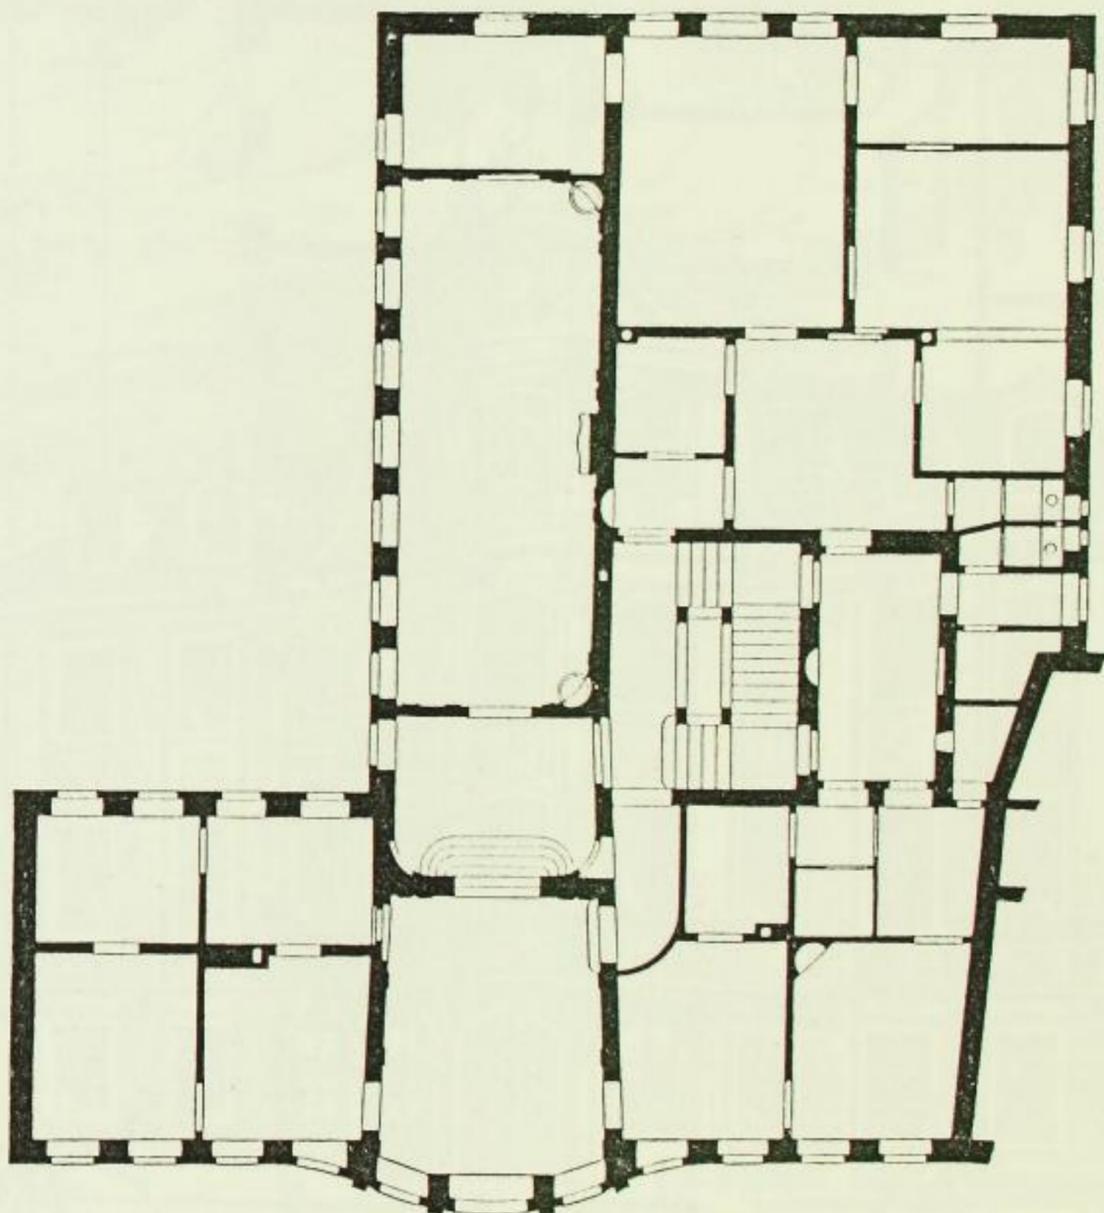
Boxberg'sches Palais. Grundriss des Erdgeschosses.
